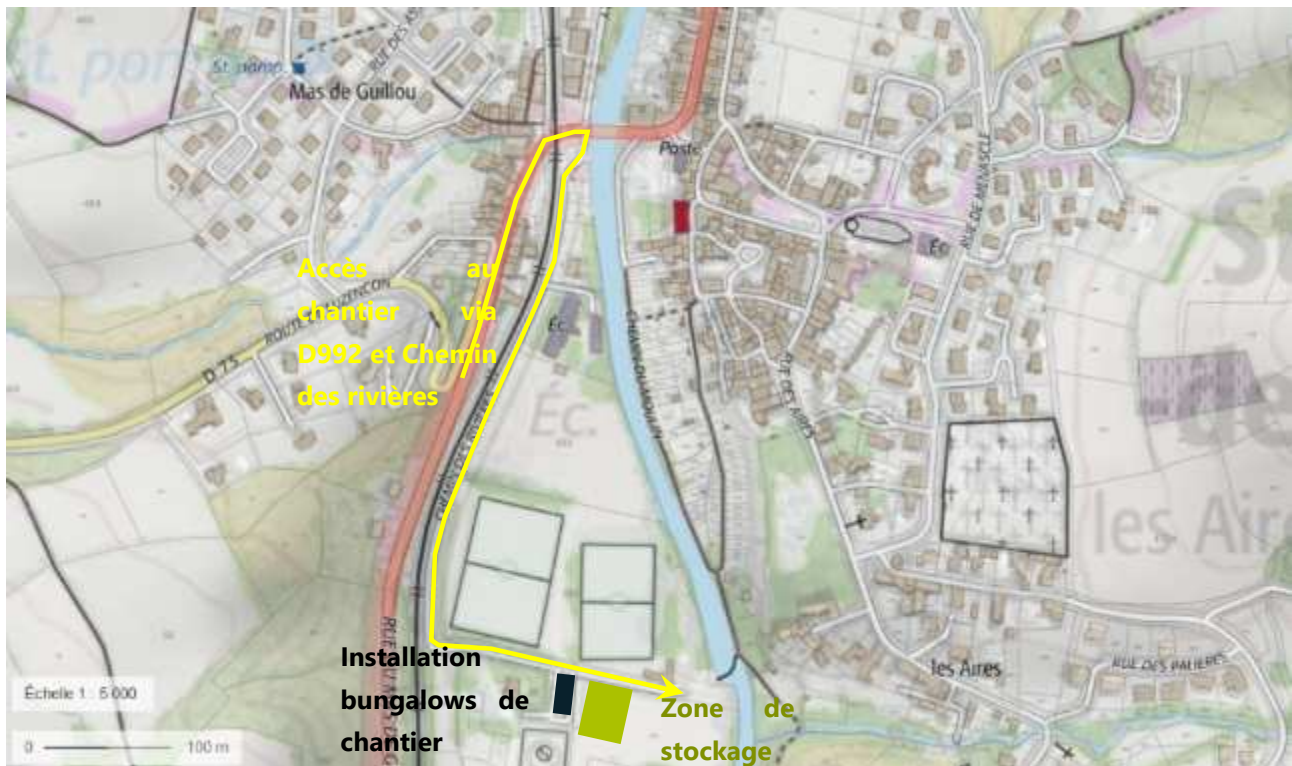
BASE VIE - INSTALLATIONS DE CHANTIER
